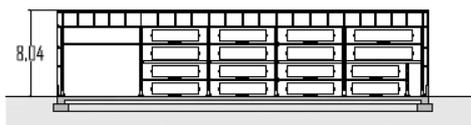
Prospetto Nord-Ovest - Schema
